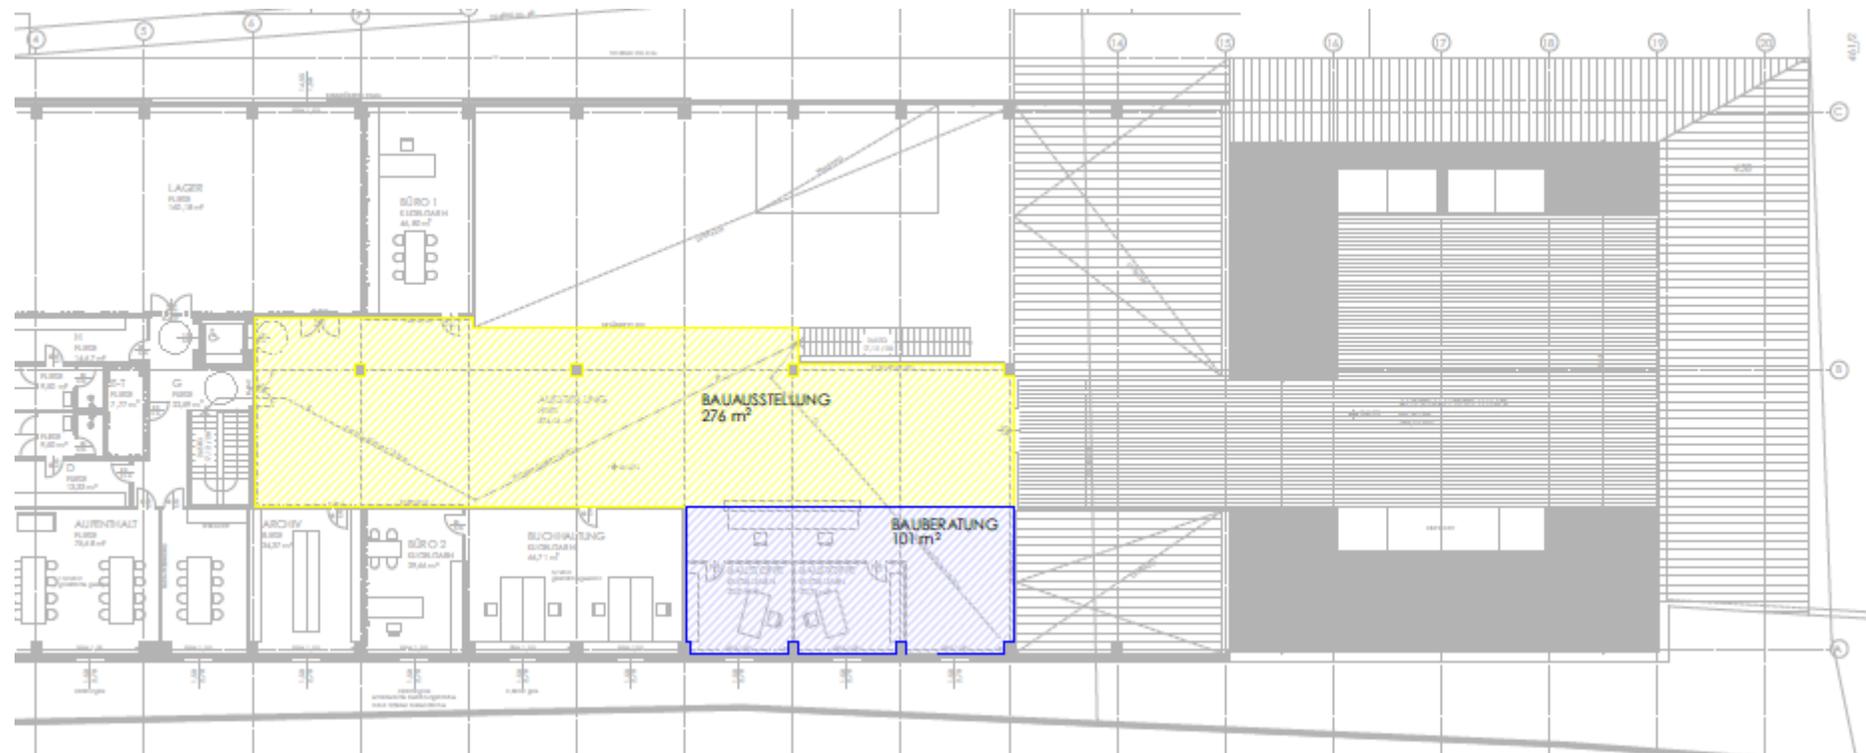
Nutzungsplan Verkaufsflächen Erweiterung nach Warengruppen, Obergeschoß
